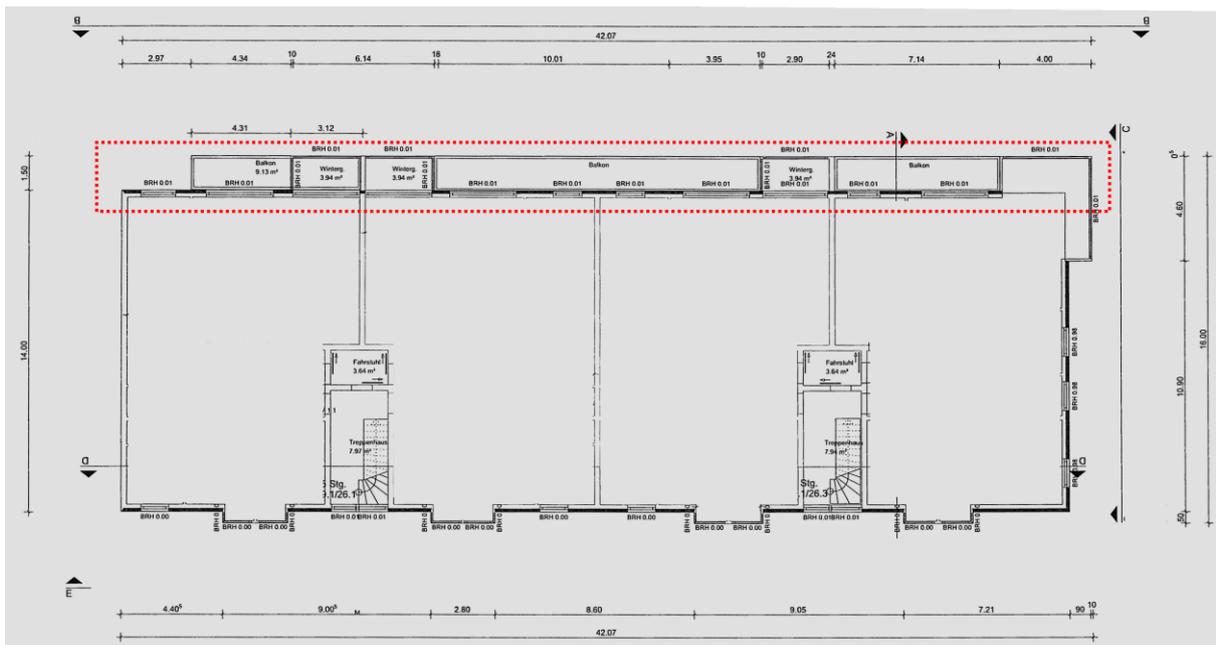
Grundriss OG mit rheinseitigen Balkonen
